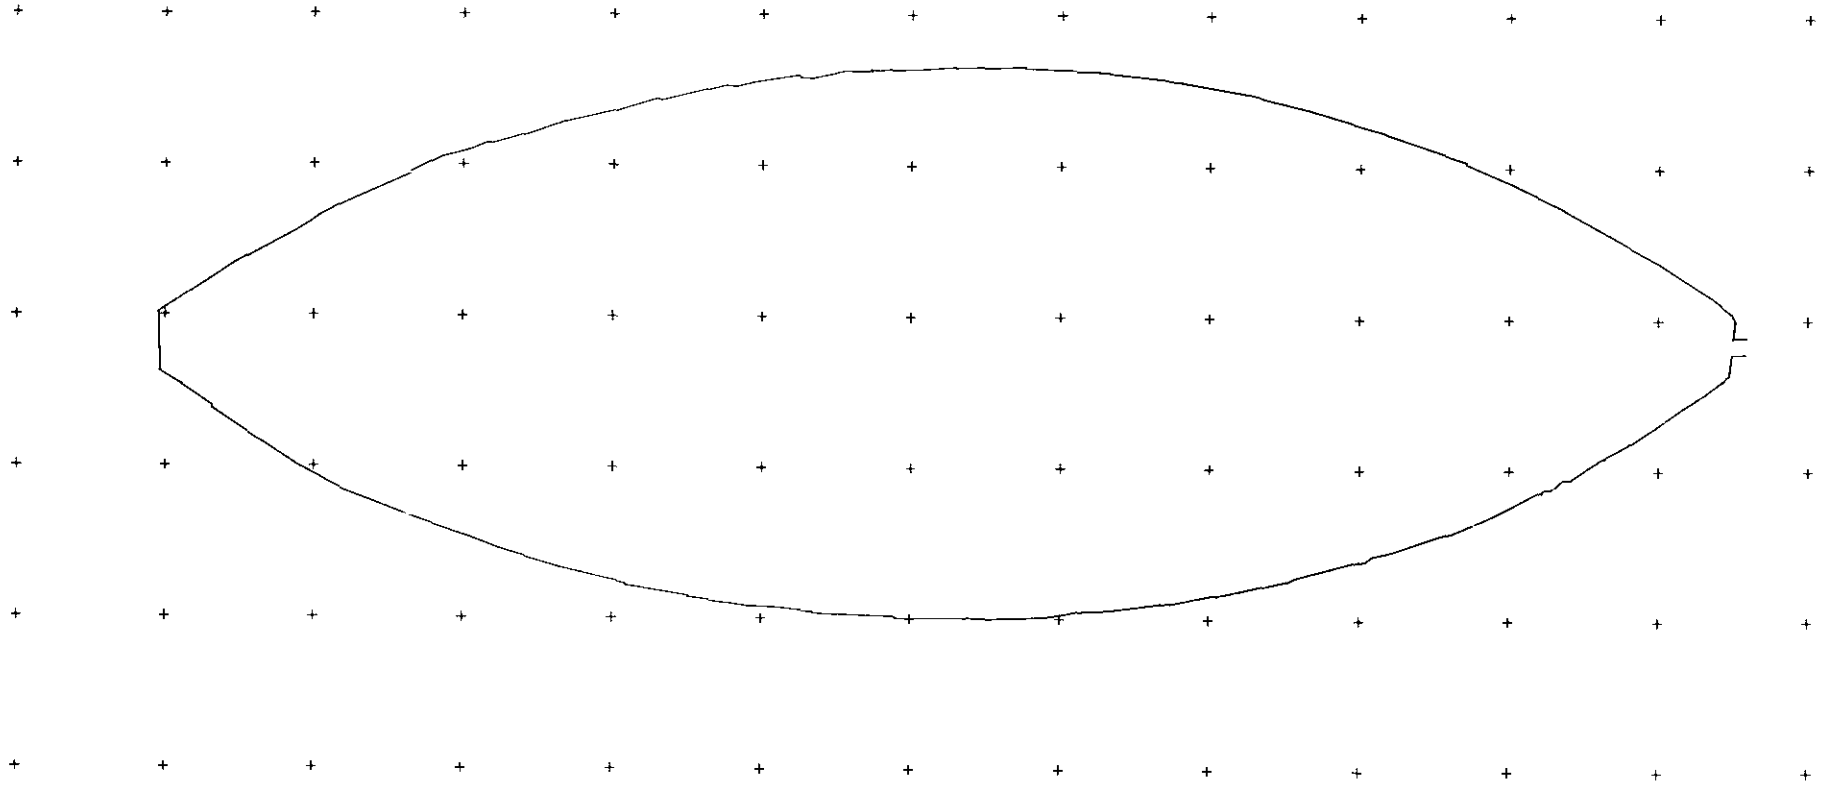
Restitución fotogramétrica de la planta a nivel de la hilada inferior.
